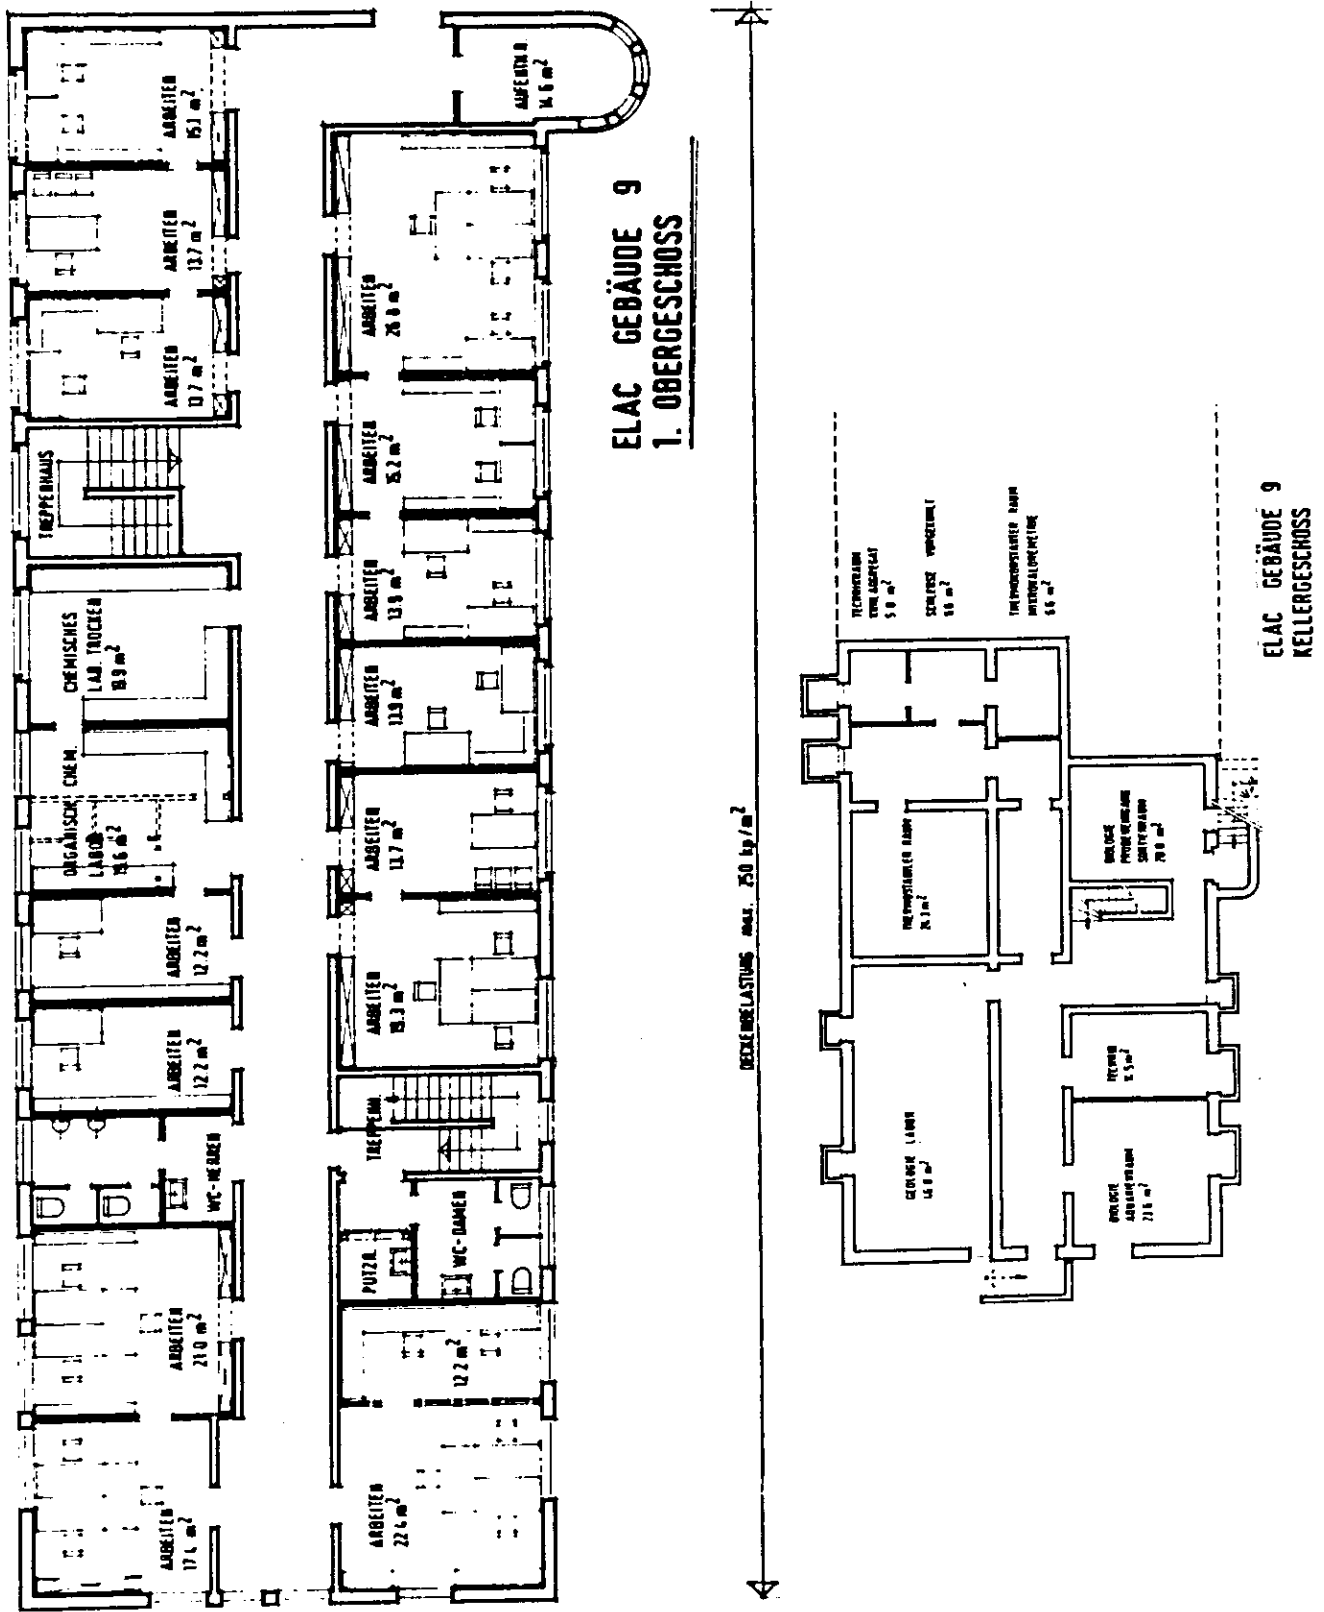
Raumaufteilung des Gebäudes des SFB 313. Hier nur Kellergeschoß und 1. Obergeschoß. Das Gebäude hat 3 Geschosse, Nebengebäude und Lagerhalle sind zusätzlich vorhanden.
